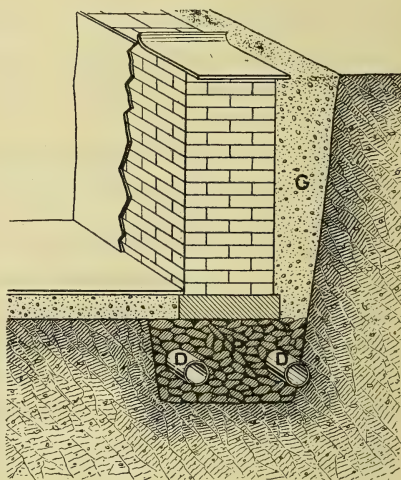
Fondation avec drainage spécial (d'après Emmerich). — D, drains en poterie; — G, gravier; — P, pierrailles.
